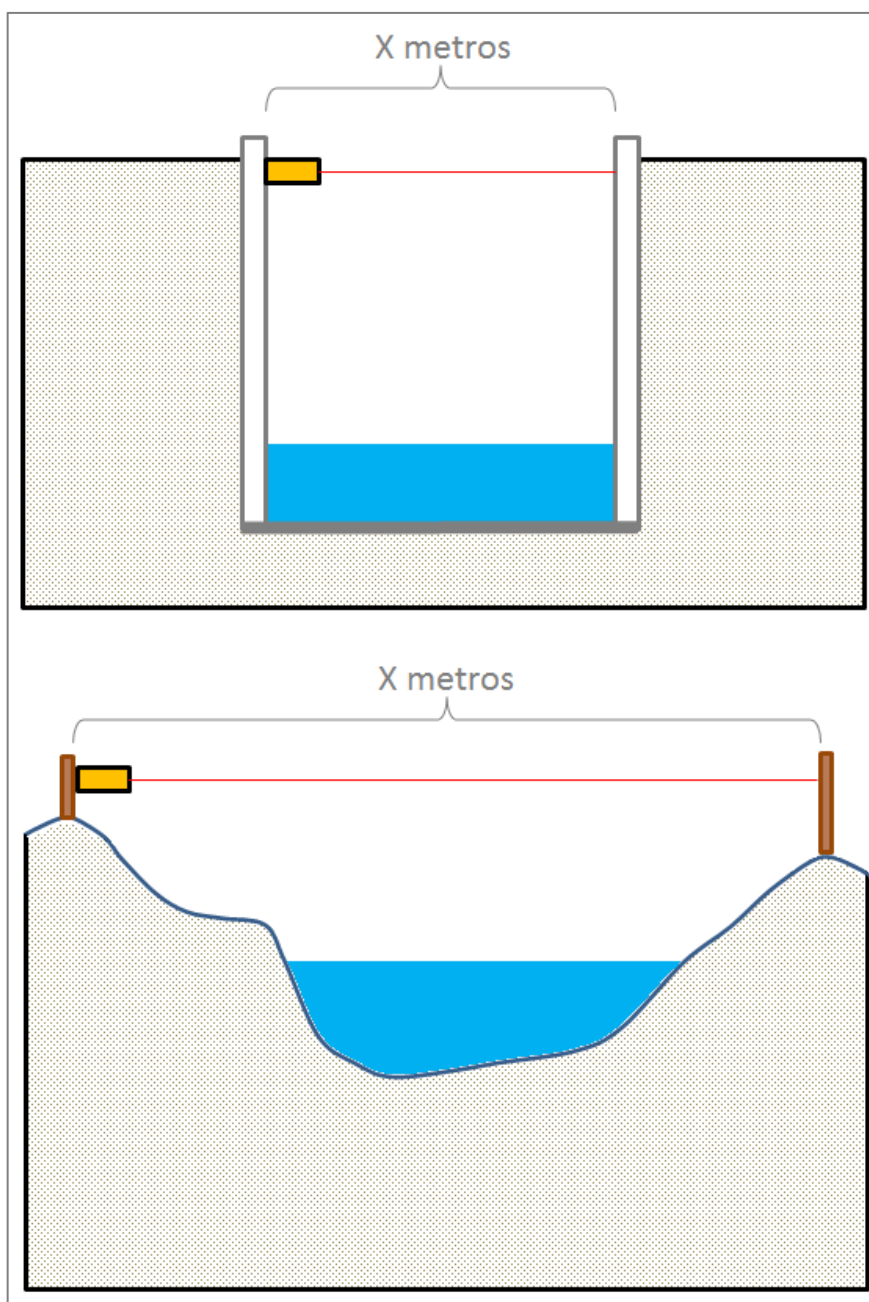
Representação dos parâmetros para medição da largura dos canais com paredes concretadas e não concretadas
